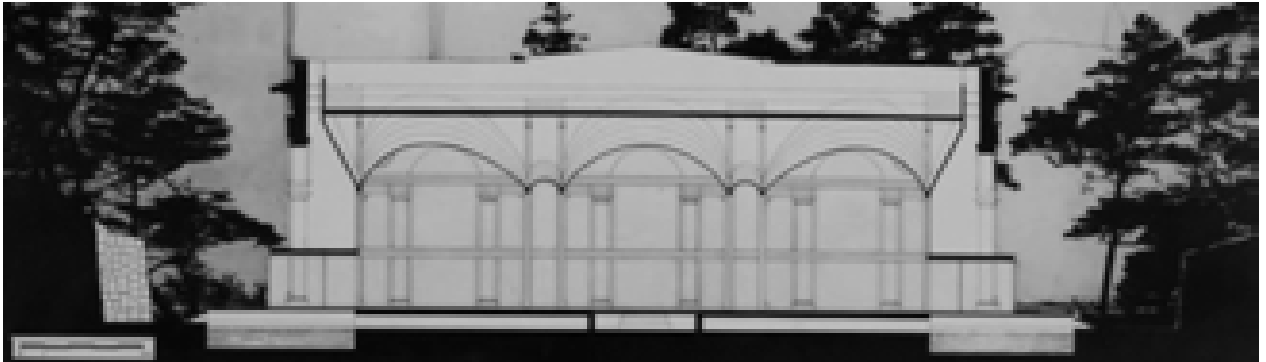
Sezione BB, stato futuro - Progetto del 15/07/1985, agg. del 15/01/1987 (AABS-913)
